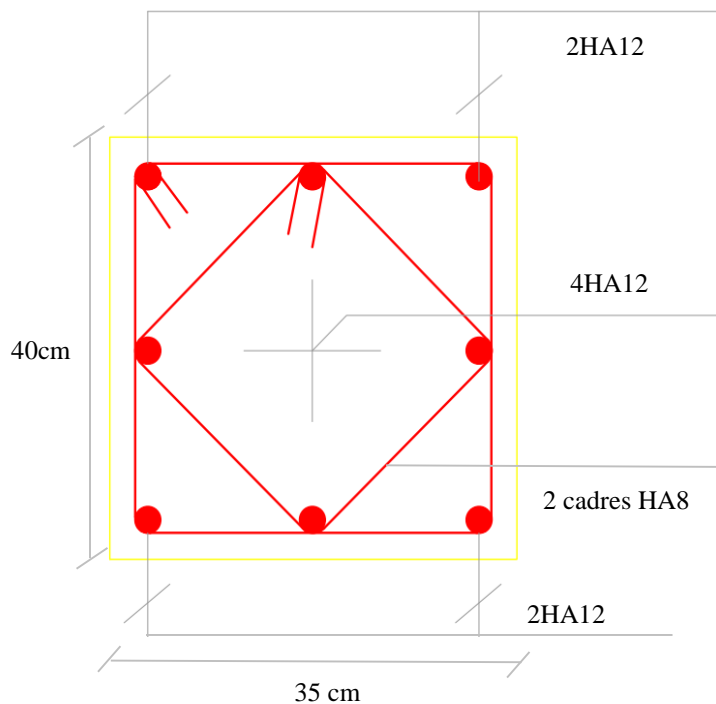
Schéma de ferrailage des poteaux d'étages 6,7,8,9
